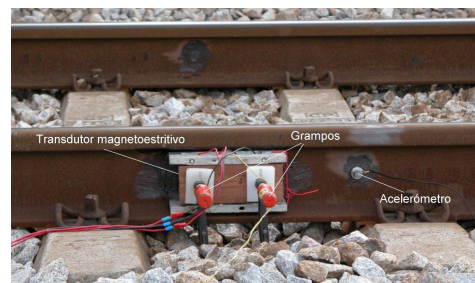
b. Fixação do transdutor magnetoestrutivo e do acelerómetro ao carril.
